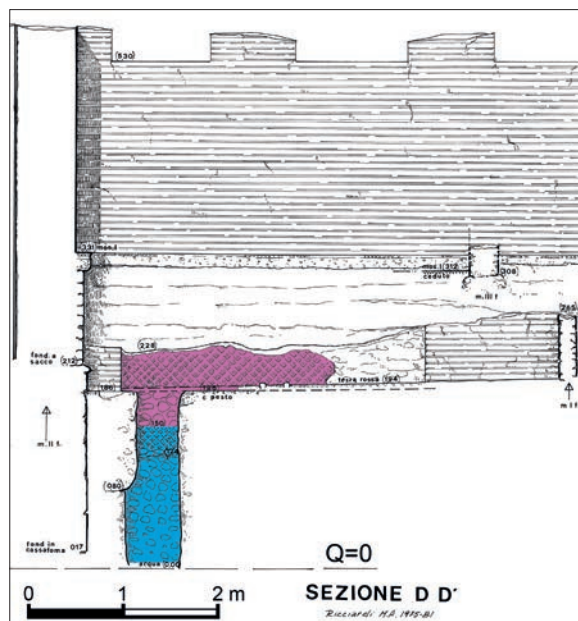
Sezione stratigrafica di un sondaggio realizzato nell'ambiente 7 del Caseggiato dei Lottatori: muro 2 (azzurro) e muro 5 (viola; riel. SSBAR 5658).
